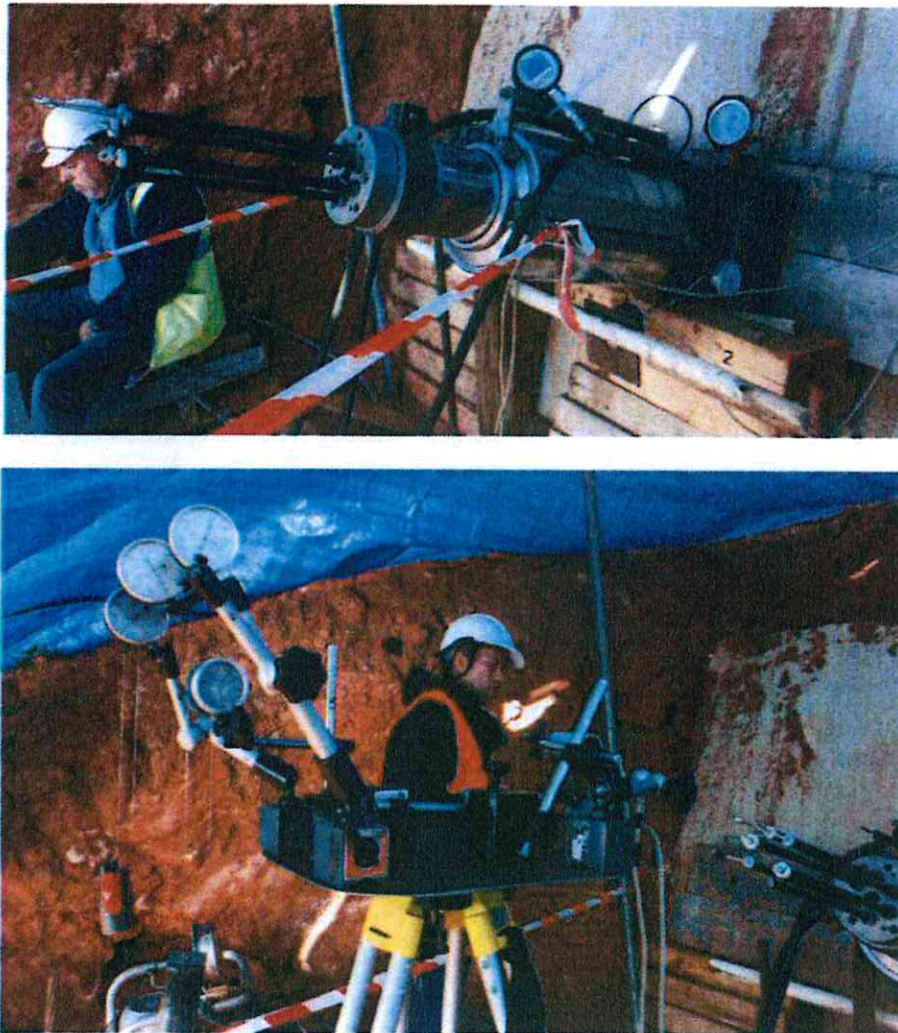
Aspeto geral do equipamento aplicado no EP3
